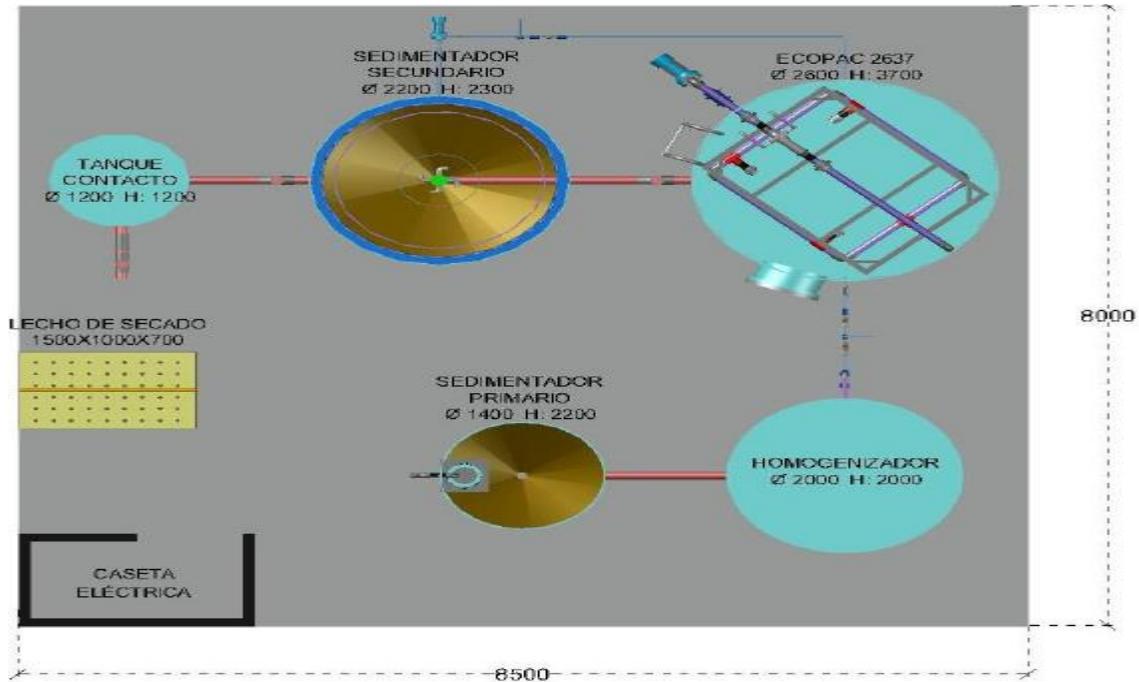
Vista en planta de la PTARD CEDI MERCADERÍAS
